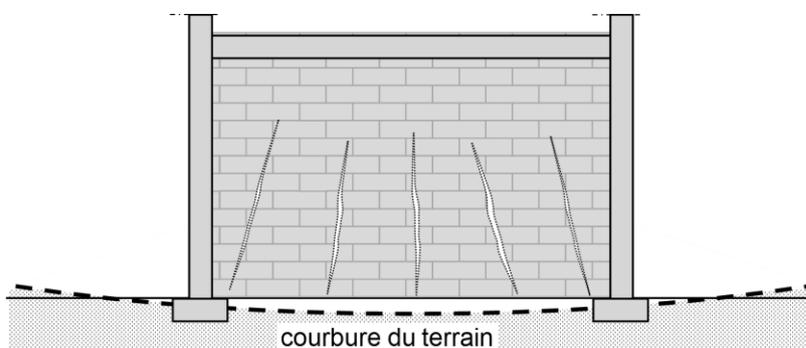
exemple de fissures verticales et diagonales induites par la courbure du terrain
